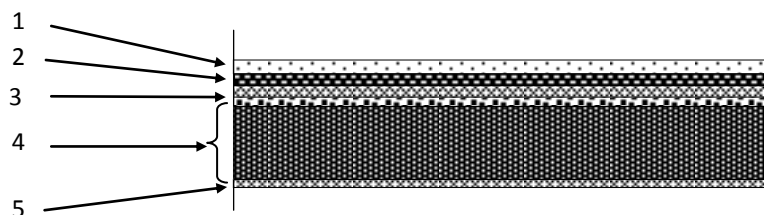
Coupe verticale d'un plancher étage courant - corps
